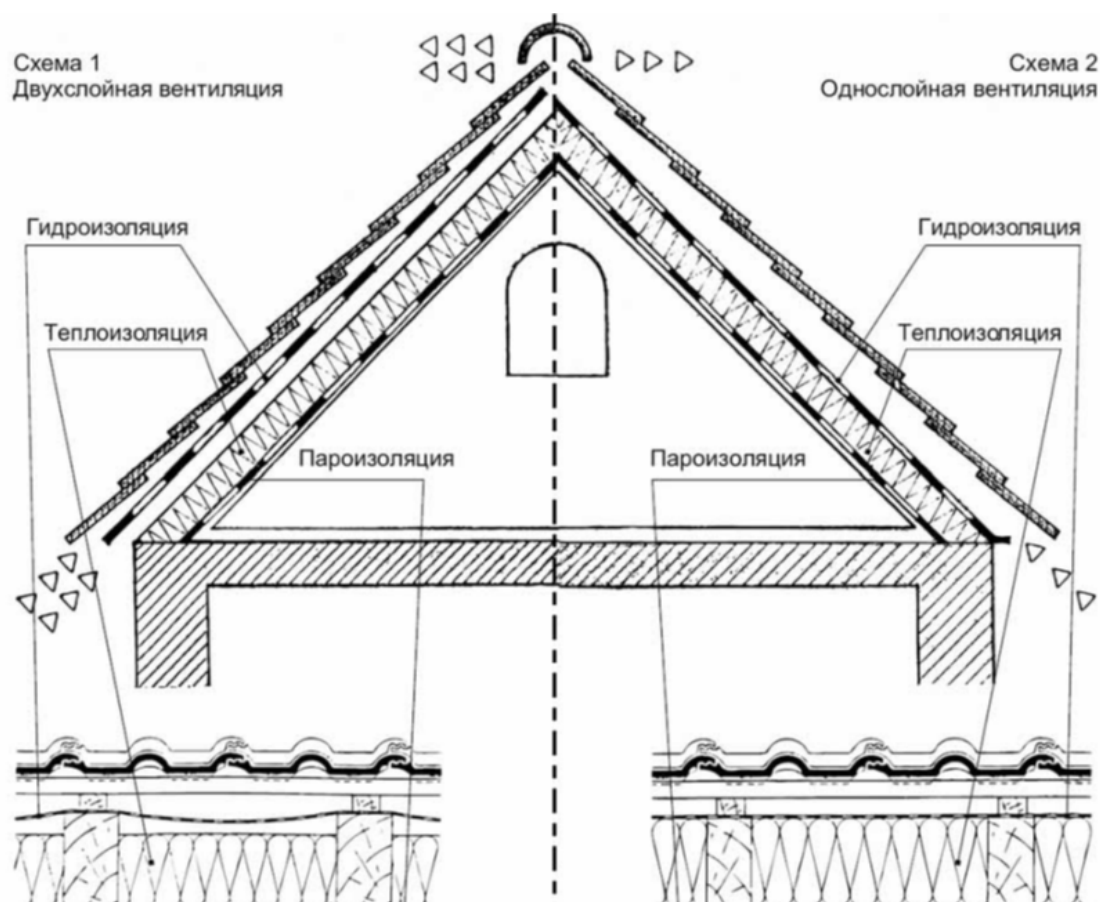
Схемы организации вентиляции подкровельного пространства
